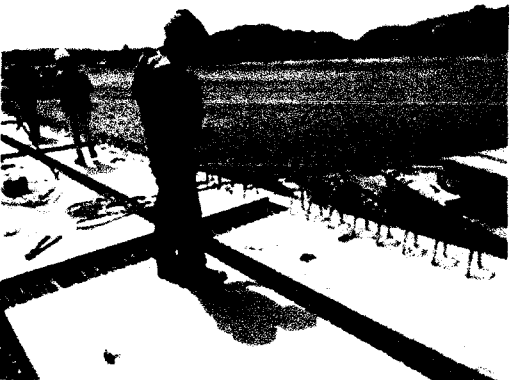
y 42: Encofrado de fondo en juntas longitudinales. MUELLE.
